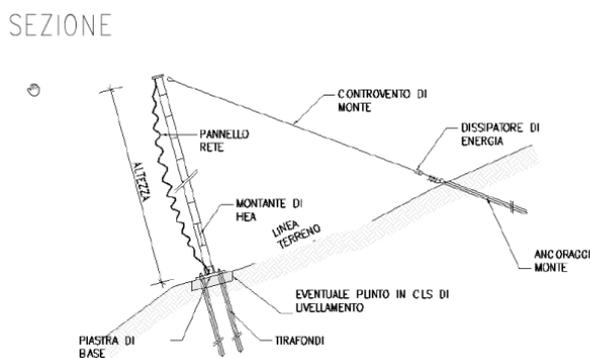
Imbocco Nord Scaleres – Barriere paramassi - sezione
